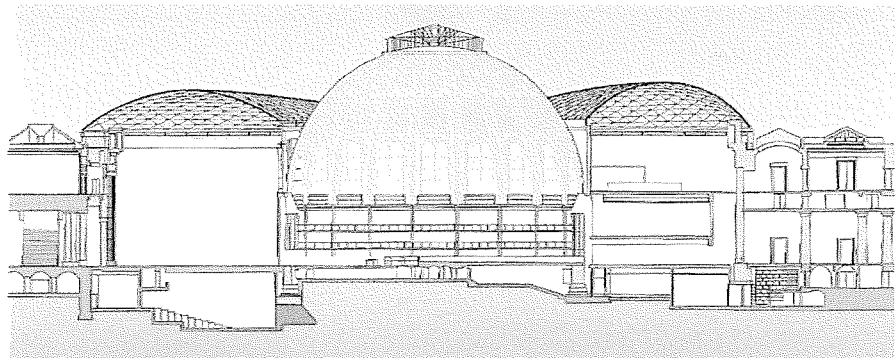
Schnitt durch den Great Court mit Reading Room. Das Dach lagert auf dem bestehenden Gebäude auf.
